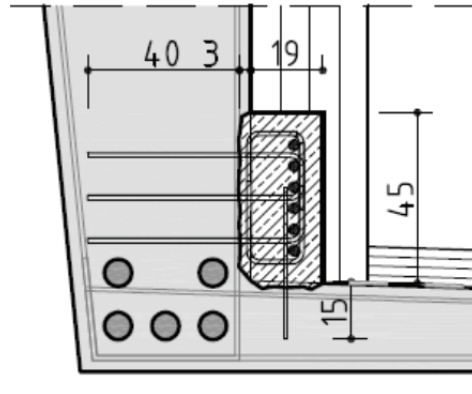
Beispiel für eine Querschnittsergänzung in Form eines anbetonierten Stahlbetonbalkens: Detail Querschnitt (Erfahrungssammlung Beispiel 7.4)
